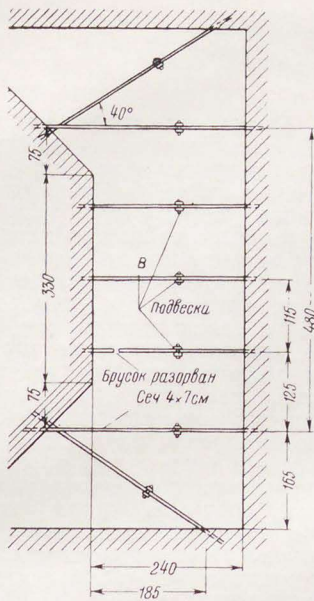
План расположения железных брусьев, поддерживающих плоское перекрытие (размеры в см)
